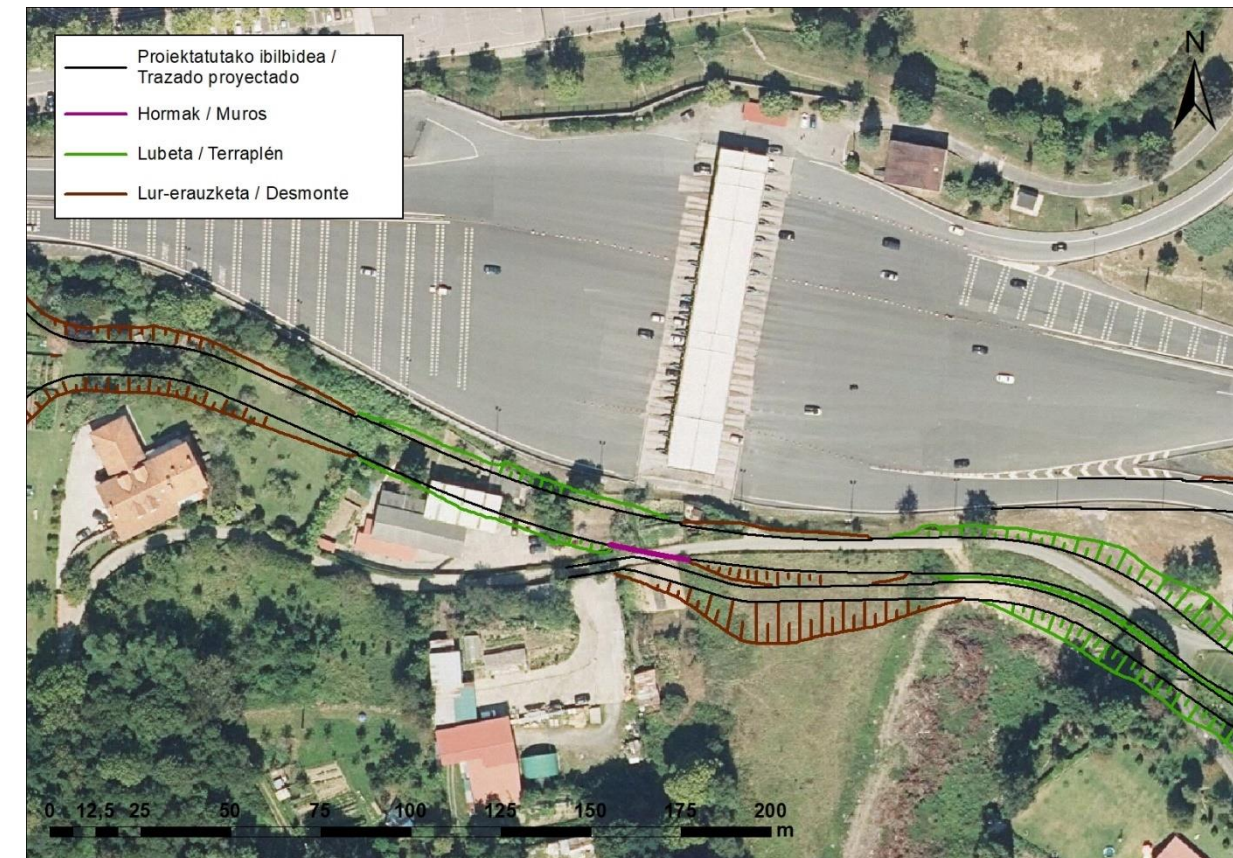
Tramo proyectado entre la Rotonda 1 y la Rotonda 2 junto a la plataforma de peaje de la AP-8.
